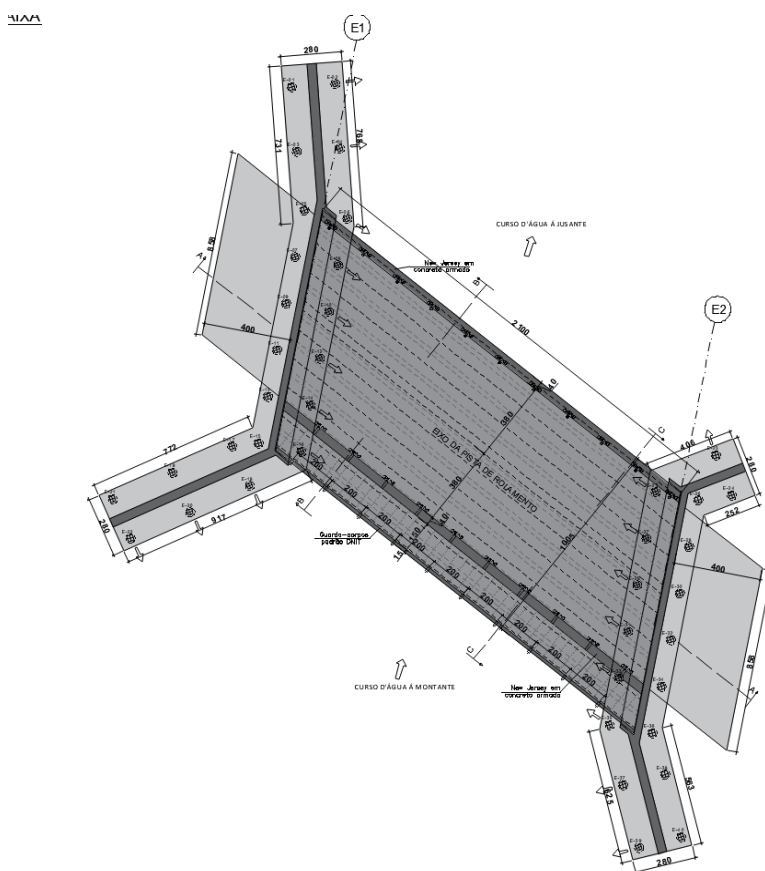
Vista Planta do Projeto Básico da Ponte localizada no futuro Contorno de Santa Maria de Jetibá / ES.
